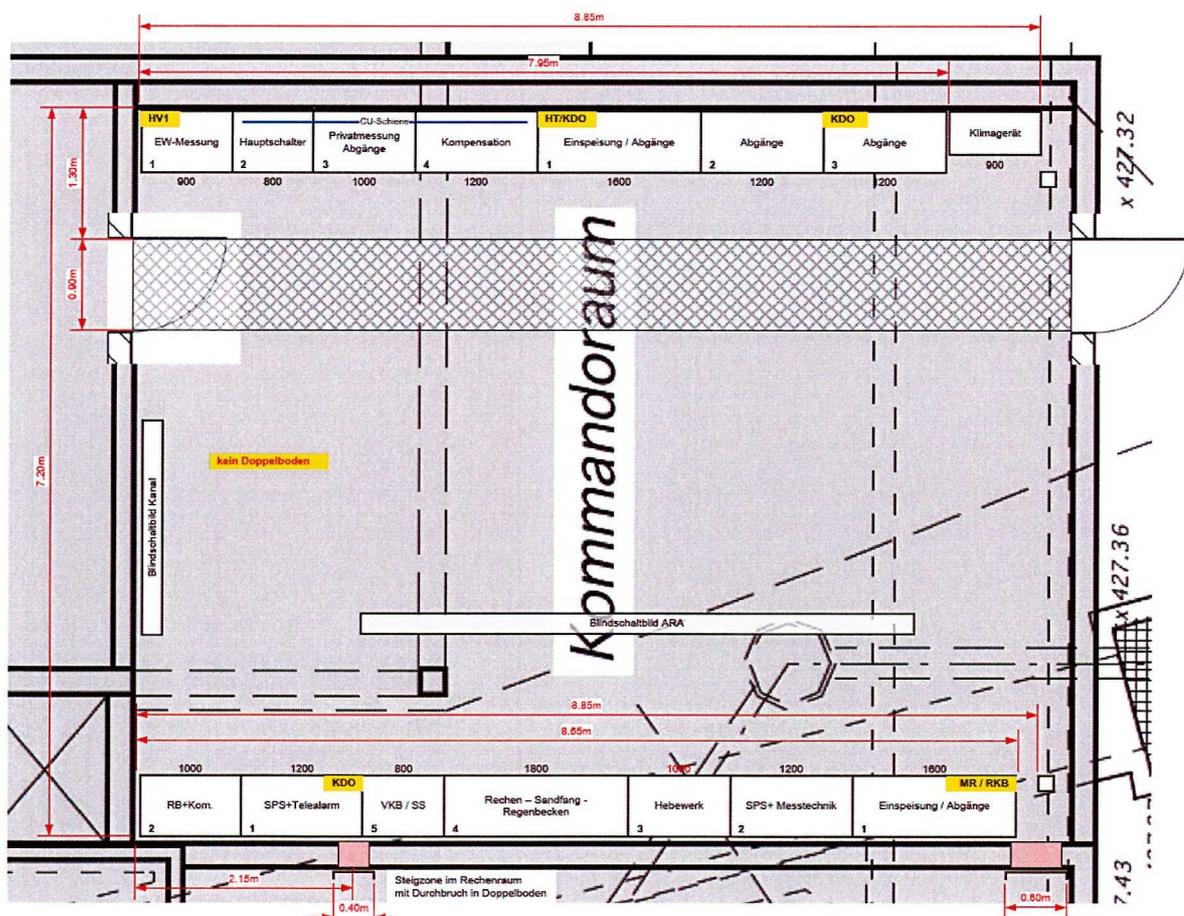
Grundriss Kommandoraum, Bestand
